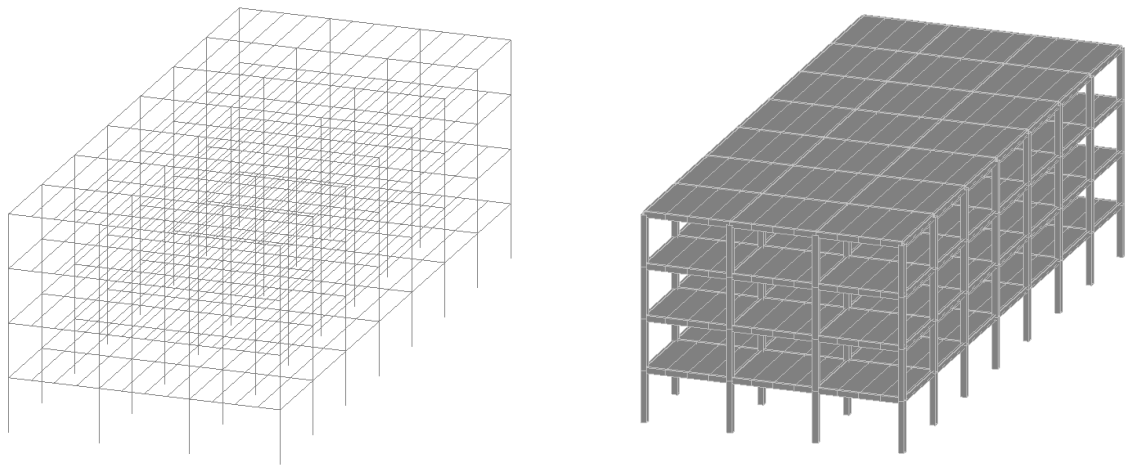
Расчетная схема каркаса сборного железобетонного здания
